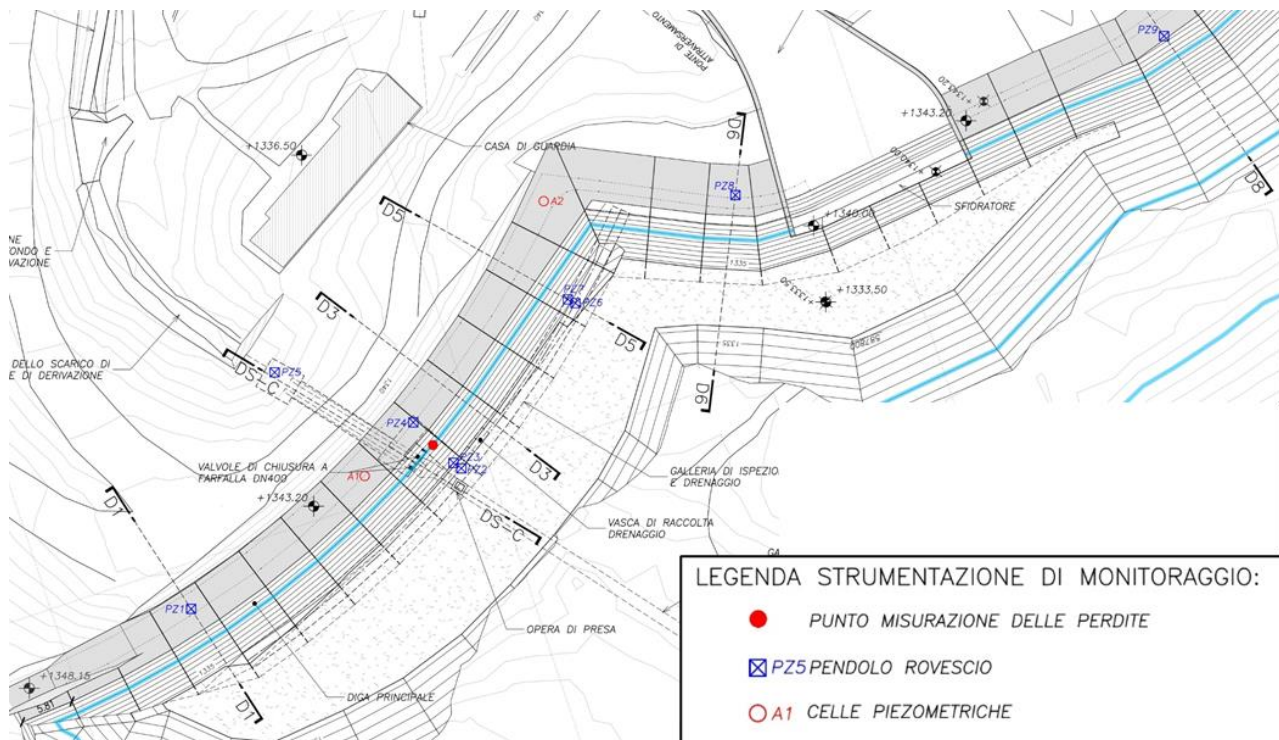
Planimetria della diga con la posizione degli strumenti di monitoraggio
